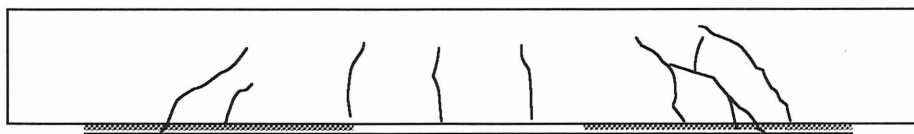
Réseau de fissuration d'une poutre typique renforcée de Carbodur S
